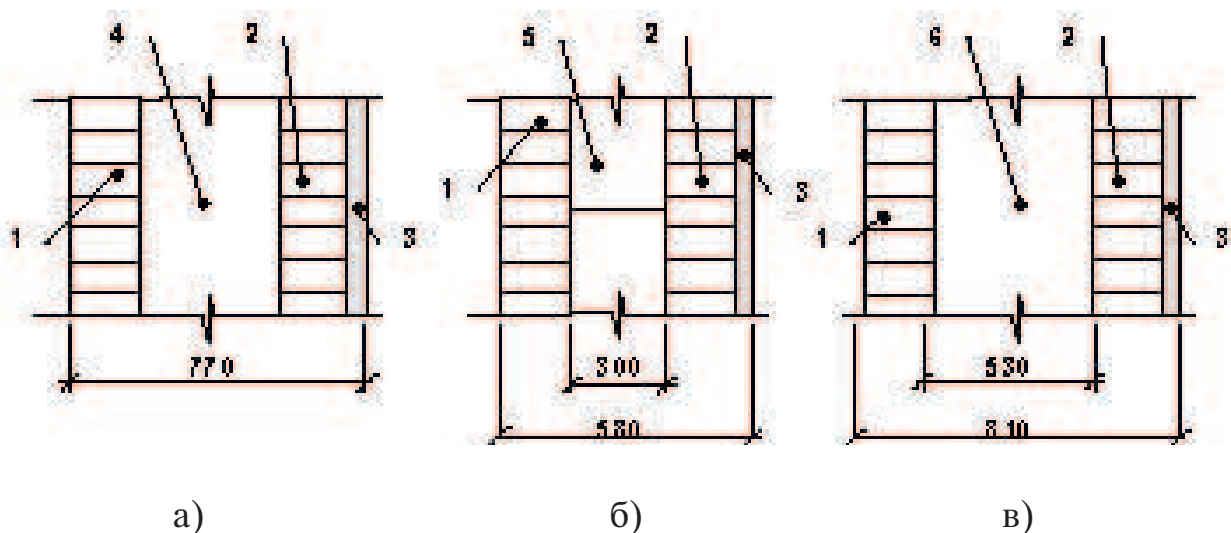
Варианты технологий утепления наружных стен при реконструкции малоэтажных жилых домов в условиях г.Санкт-Петербурга: традиционная кладка (а); многослойные кирпичные кладки (б, в):
